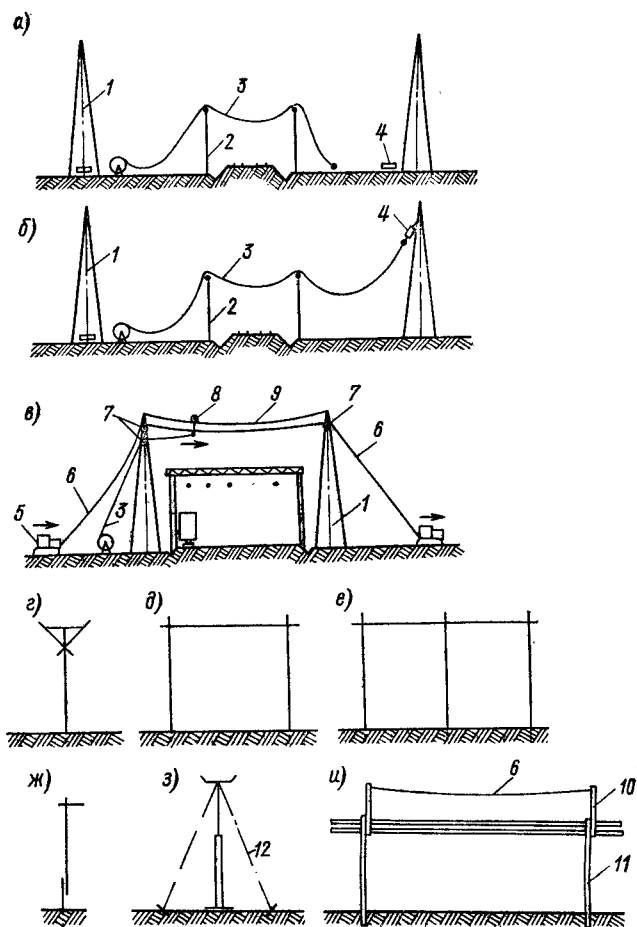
Монтаж проводов на переходах через транспортные магистрали; а — протаскивание провода над железнодорожными путями; б — подвеска провода на первую анкерную опору; в — перетягивание провода с помощью ролика, подвешенного на тросе; г — е — одно-, двух- и трехстоечные защиты; ж — крепление стойки к приставке для возможности использования защиты на другом переходе; з — металлическая защита с оттяжками; и — защита из троса, натянутого между удлиненными столбами линии связи 1 — анкерная опора; 2 — защита; 3 — провод; 4 — гирлянда изоляторов; 5 — трактор; 6 — канат; 7 — блок; 8 — ролик, перекатывающийся по грозозащитному тросу; 9 — грозозащитный трос; 10 — удлиненные столбы; 11 — столб линии связи; 12 — оттяжка
